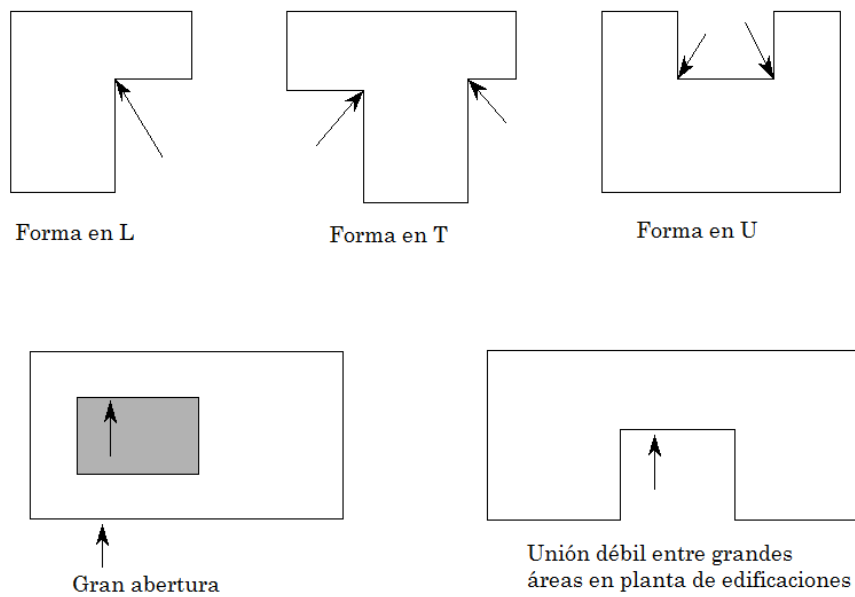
Vista en planta de configuración de edificaciones con esquinas reentrantes y aberturas.
